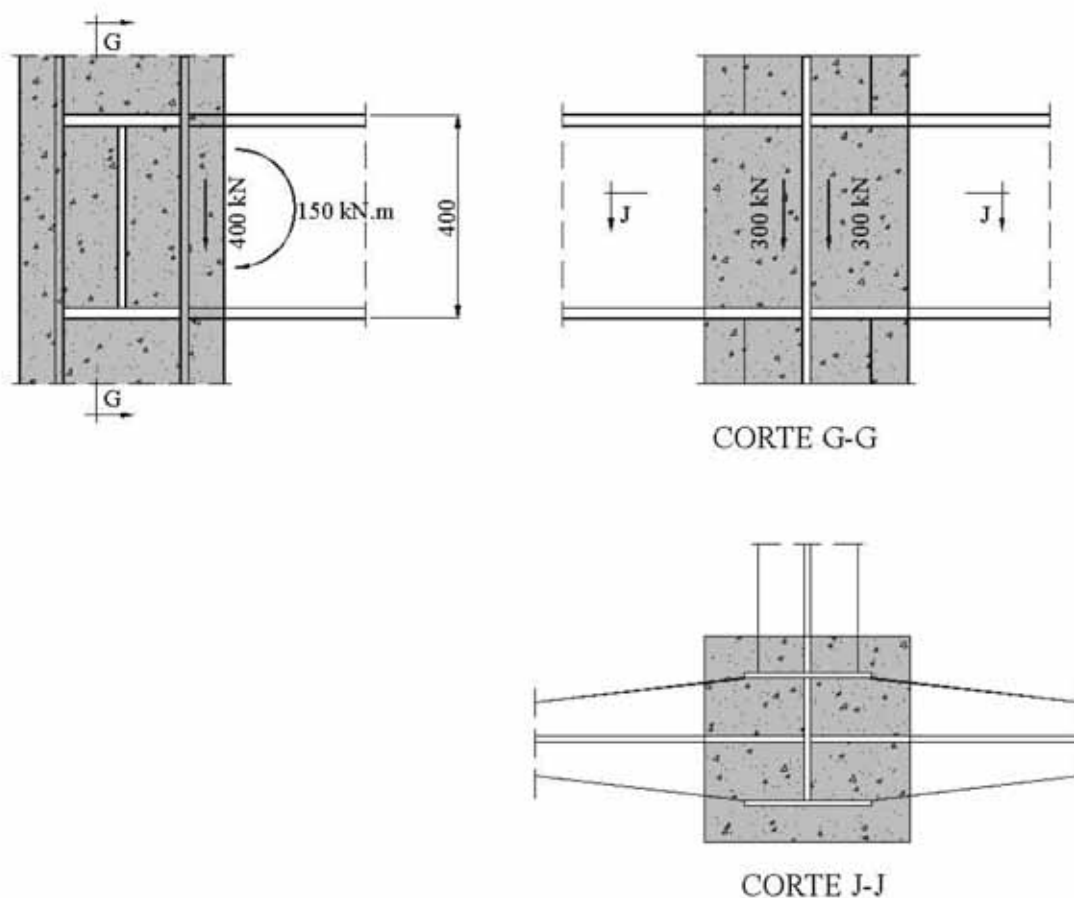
Construção do nó B (as chapas verticais ligadas ao pilar devem ter furos para permitir a passagem da armadura transversal)
